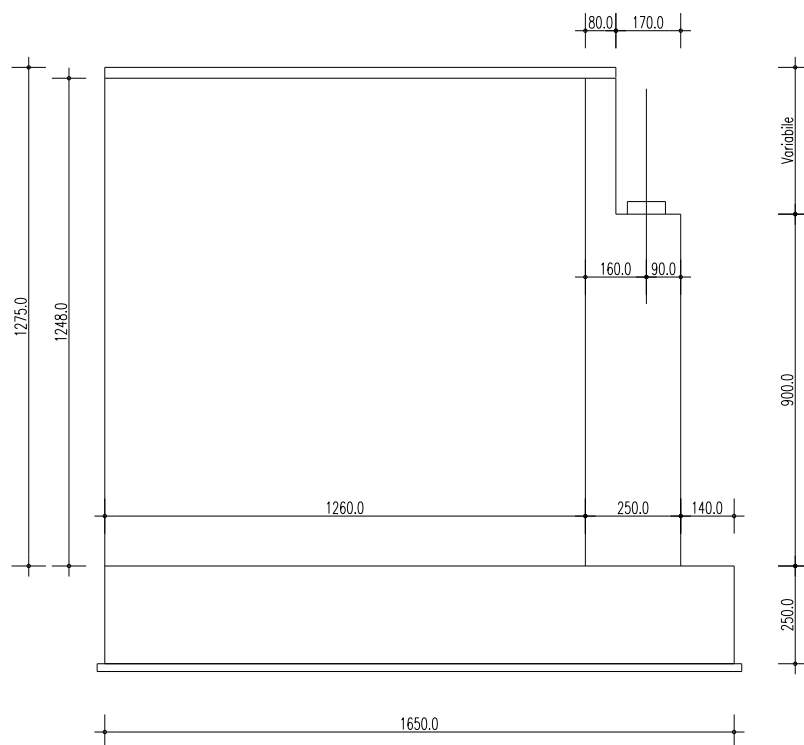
Vista laterale Spalla A-p.
